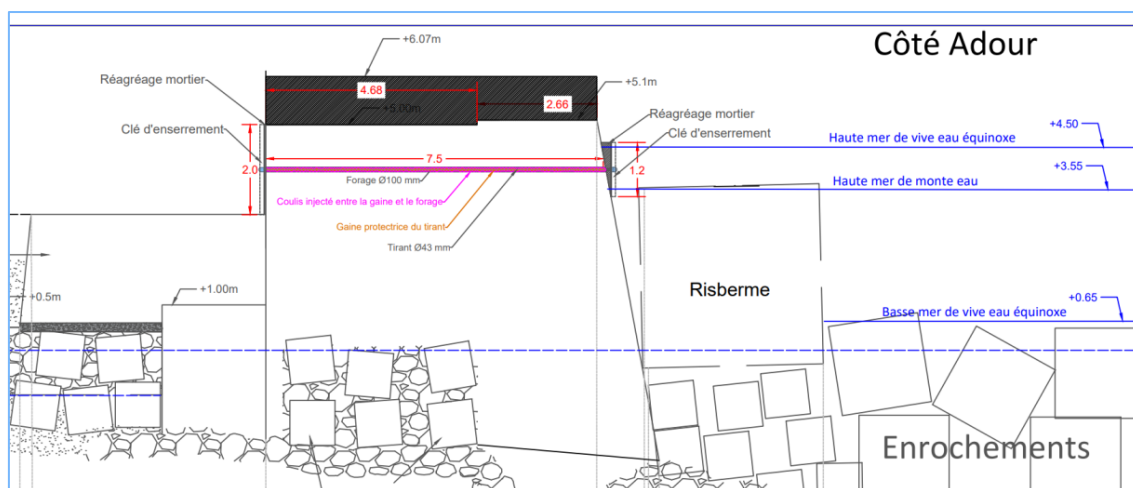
Schéma d'un tirant traversant dans le plan de coupe du musoir
